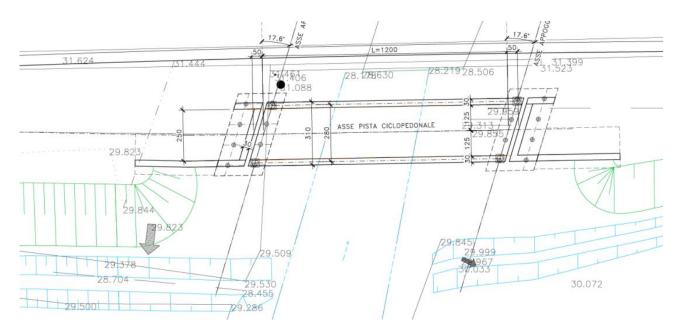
Ponte ciclopedonale sullo scolo Cordano- Planimetria.
